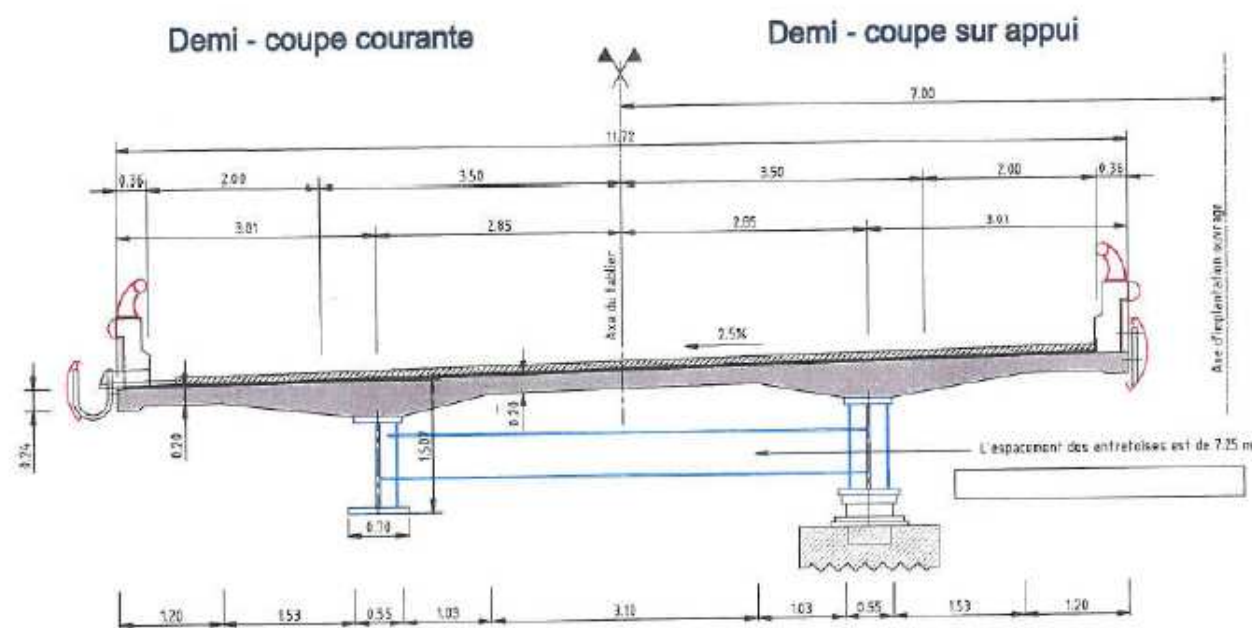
Coupe transversale du tablier actuel (source EPOA 1999 – SETRA)
